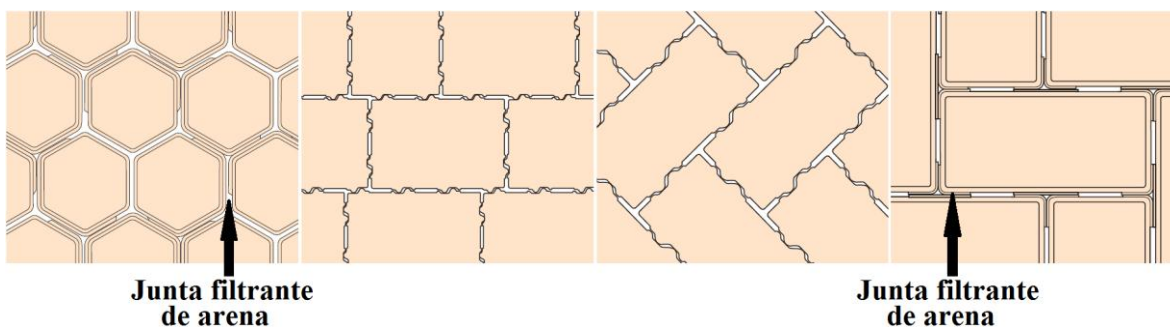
Juntas filtrantes en pavimentos de adoquín. (Adaptado de: Interpave, 2008).
